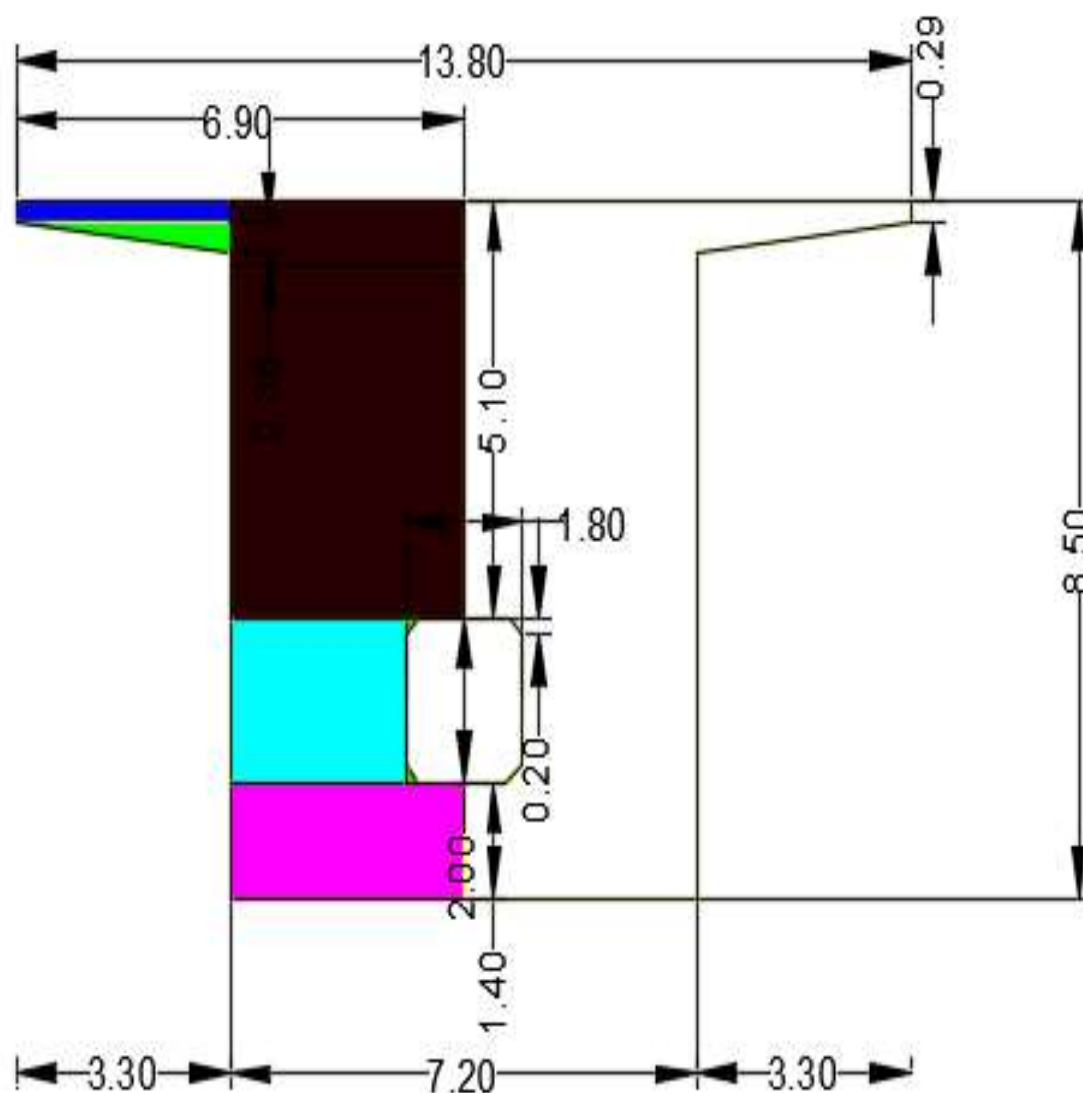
Coupe transversale du voussoir plein sur pile.
